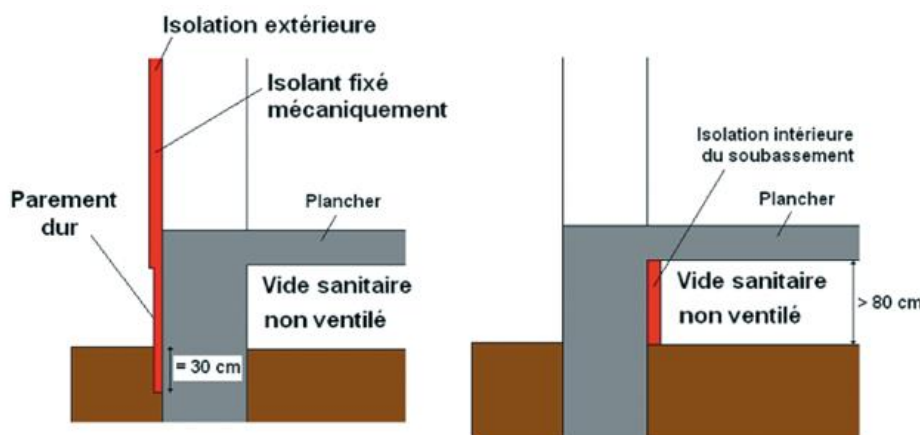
Isolation des planchers bas sur vide sanitaire (GIZ)
